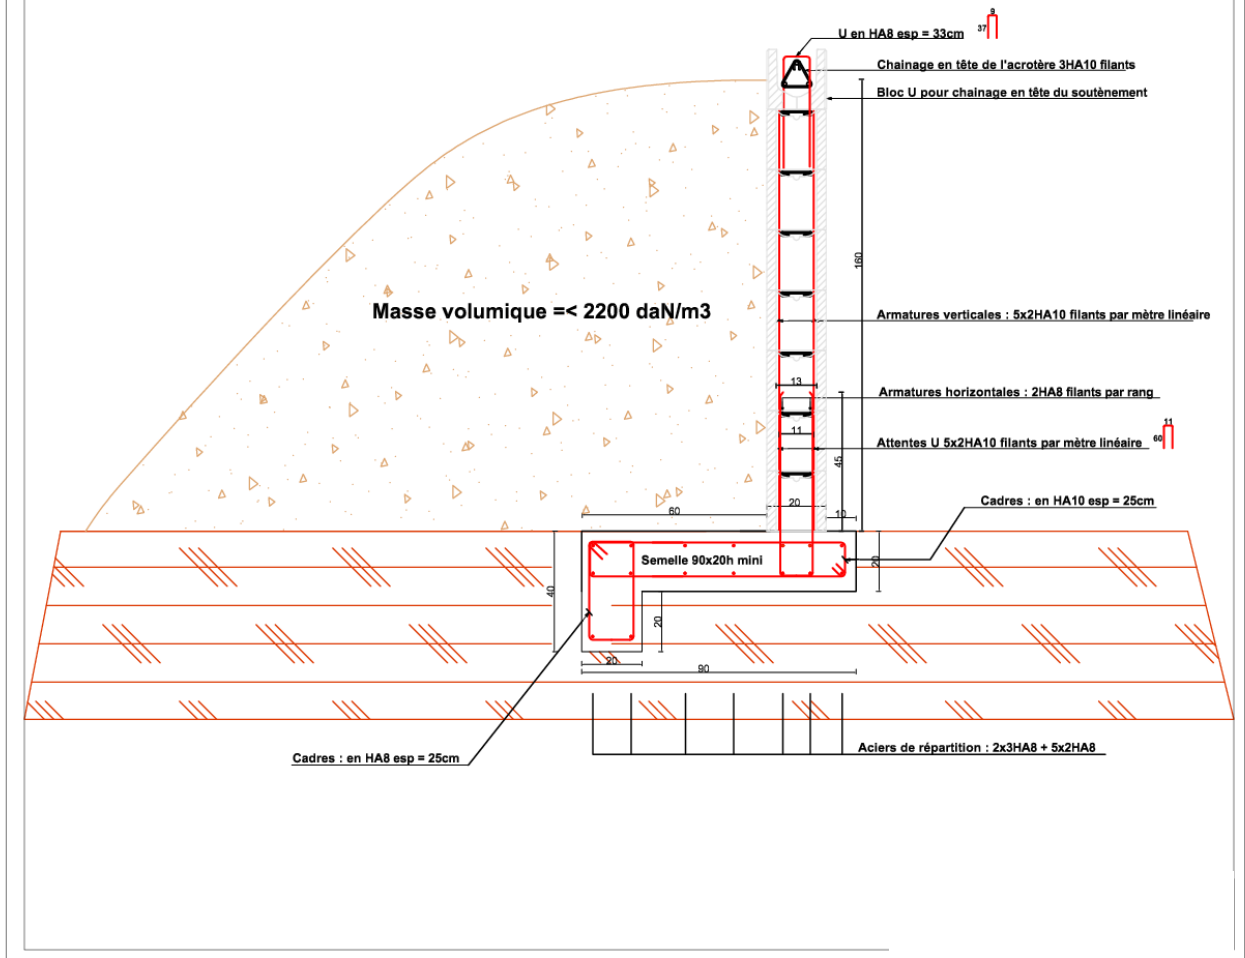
Ferrailage vertical et horizontal – Soutènement (blocs 600x200x200) sur semelles sans bêche
